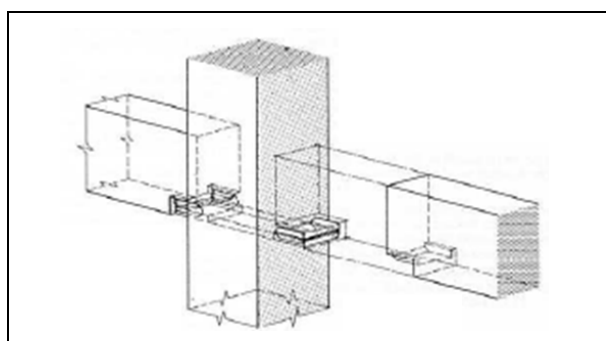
Ligação por consola curta metálica (Stupré, 1981)
